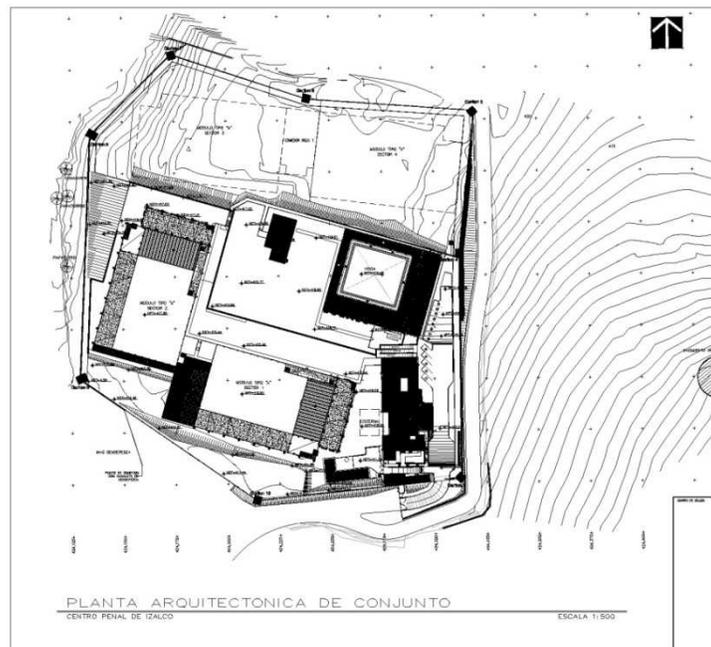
Planta de Conjunto y Techos del Comp. Penit. Izalco Fase 1, "Como Construido"
